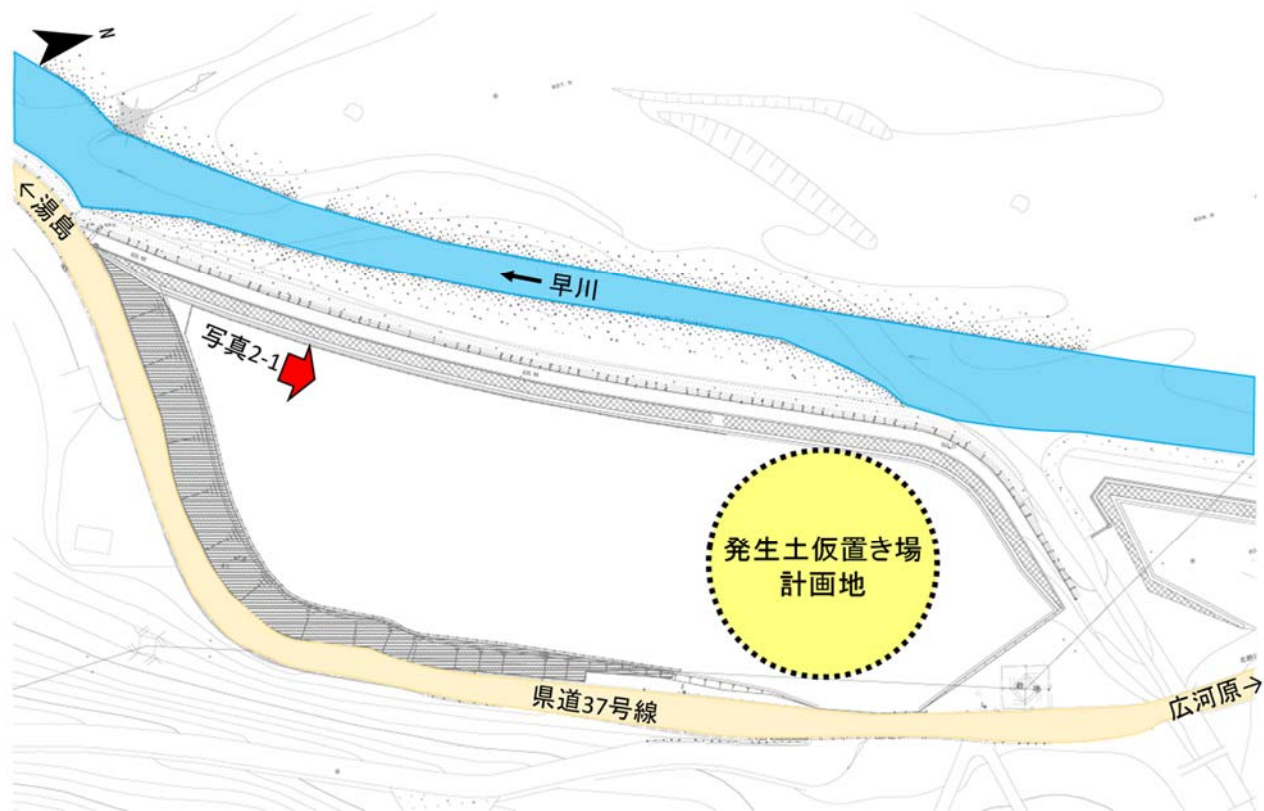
奈良田地区発生土仮置き場計画地平面図（現況）
